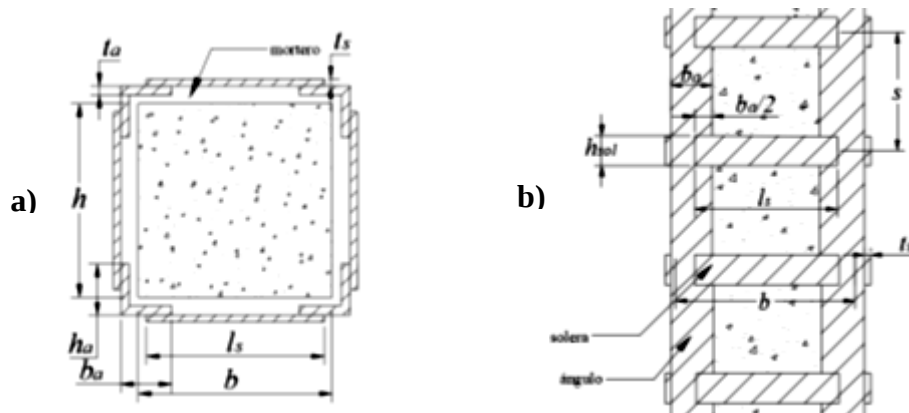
Encamisado con ángulos y soleras en columnas: a) sección transversal y b) sección longitudinal, adaptado de Alcocer *et al.* (2019).
